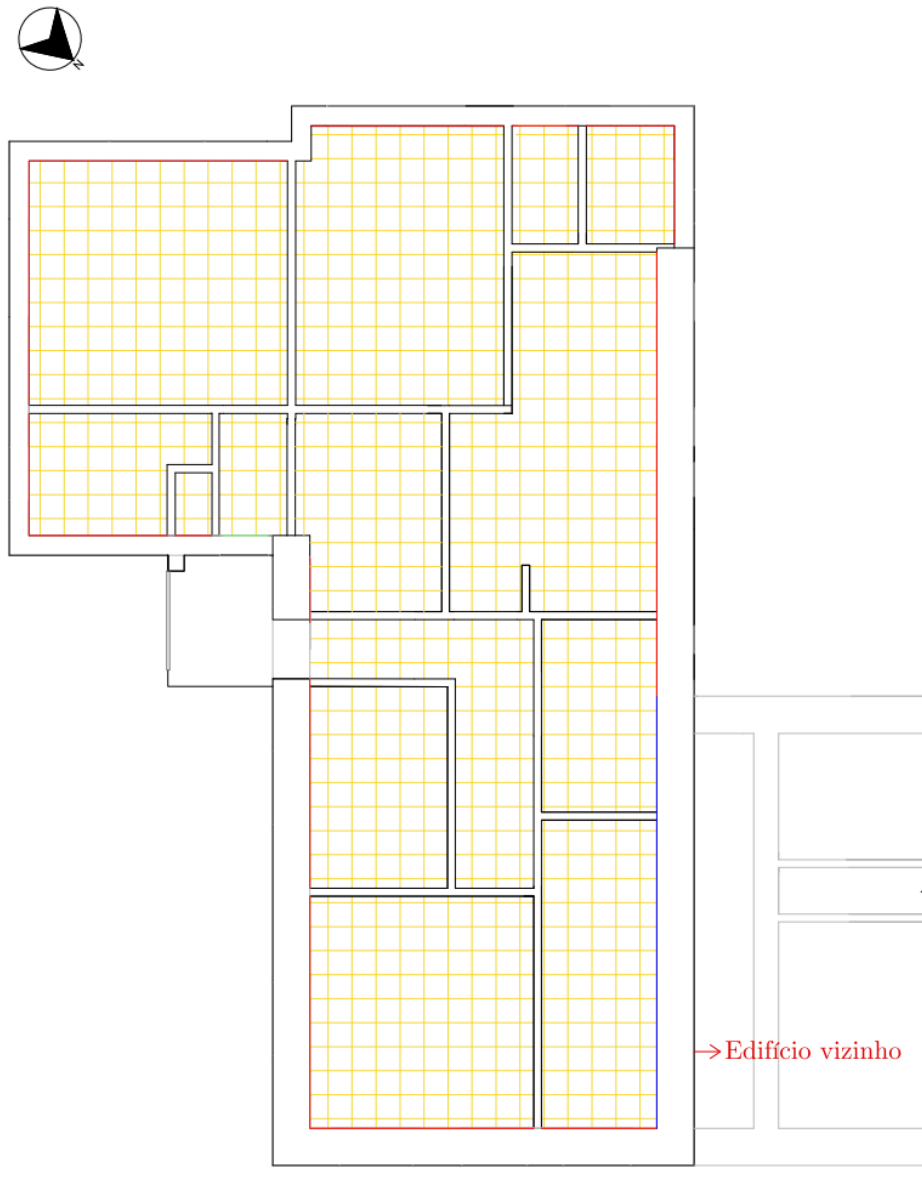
Envolventes em planta ao nível da laje de teto do edifício em estudo.
